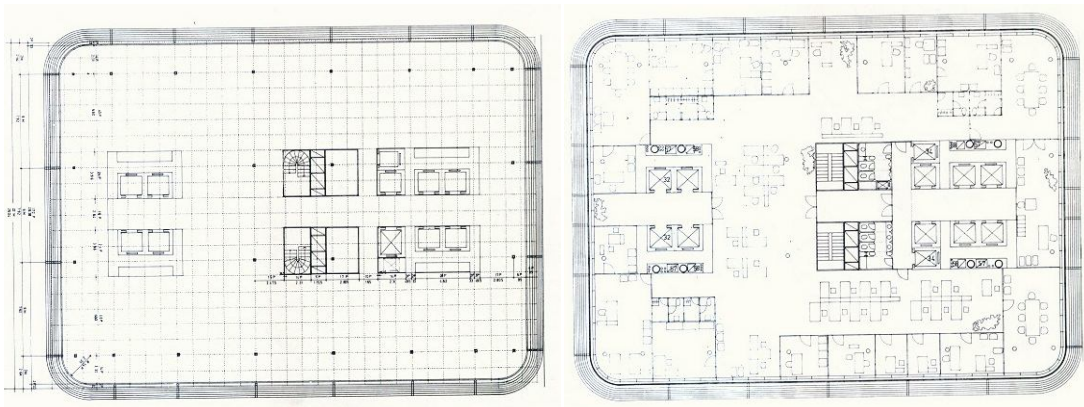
, Esquema compositivo de planta e Planta exemplo. Fonte: El croquis Abril 1988.
